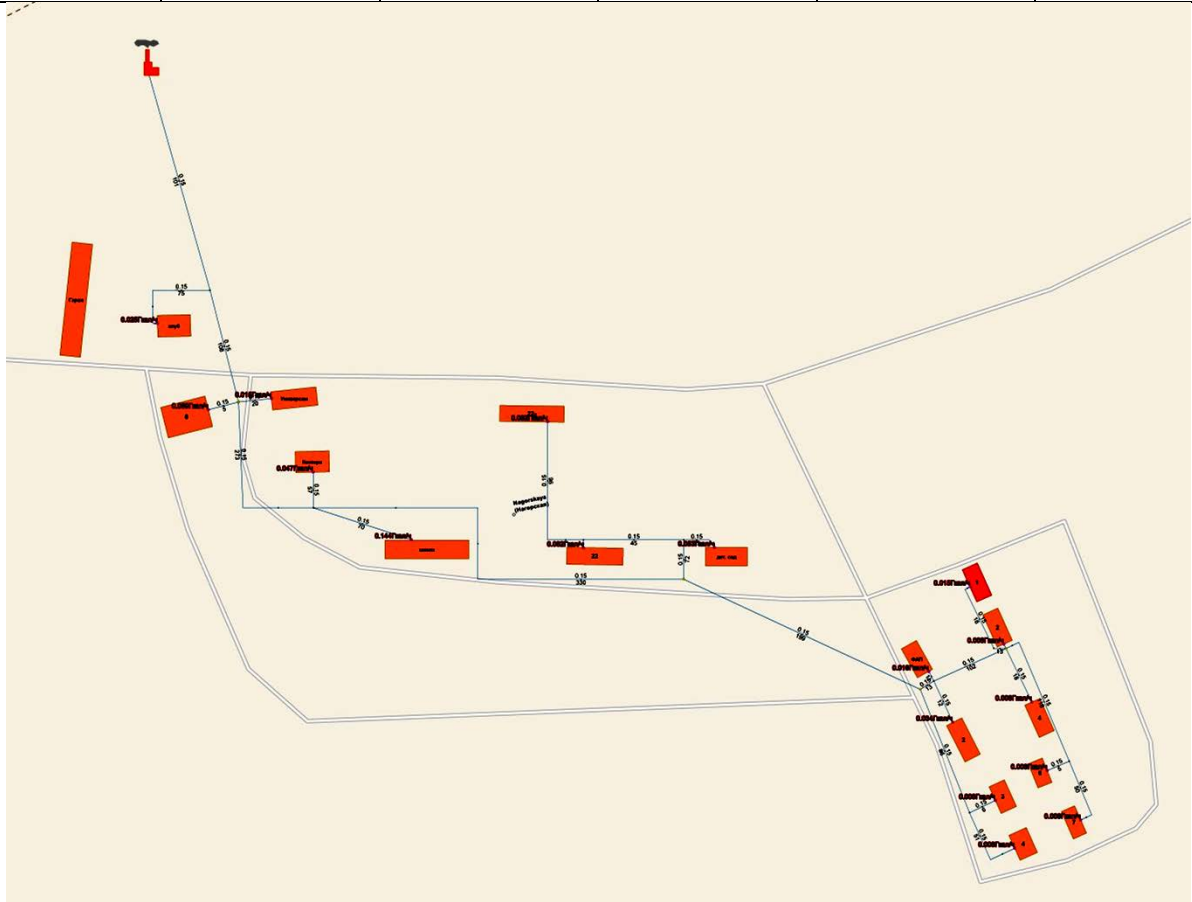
Тепловые сети и тепловые нагрузки на расчетный период
